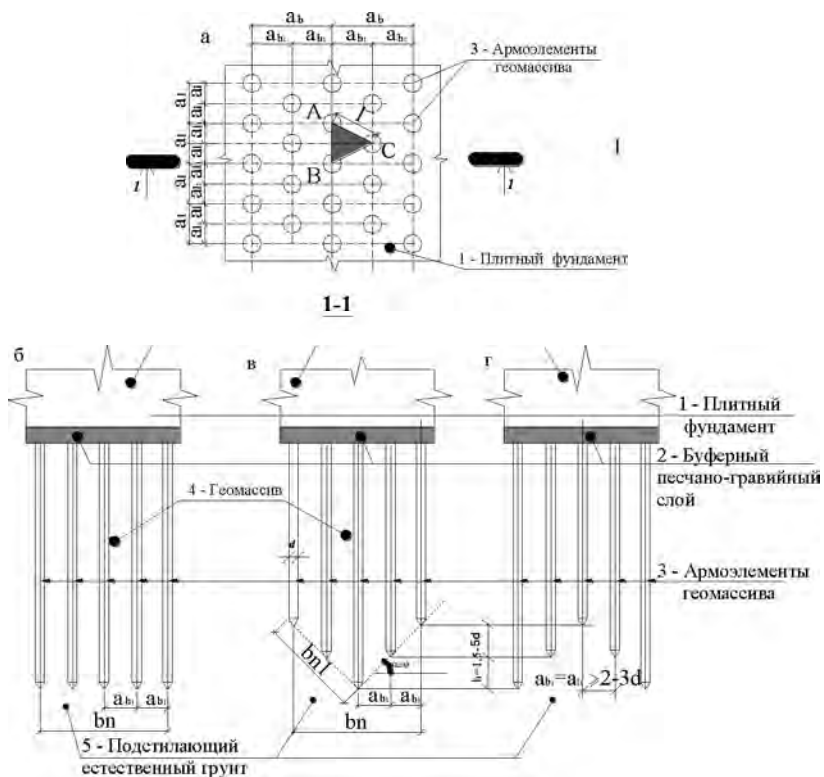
Схема вертикального армирования основания (геомассива) плитных фундаментов:
